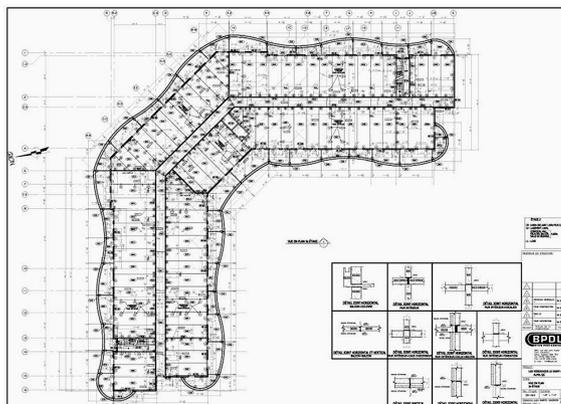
PLANTA DO PAVIMENTO TIPO
